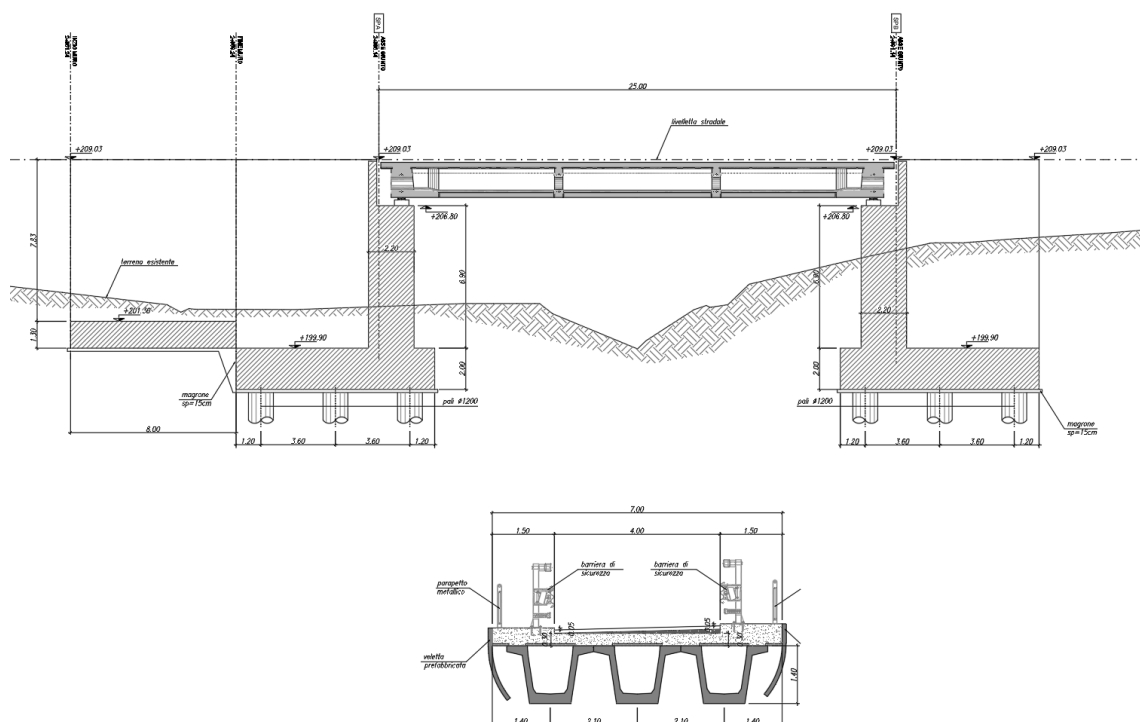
Sezione tipo viadotti stradali V04 e IV05
